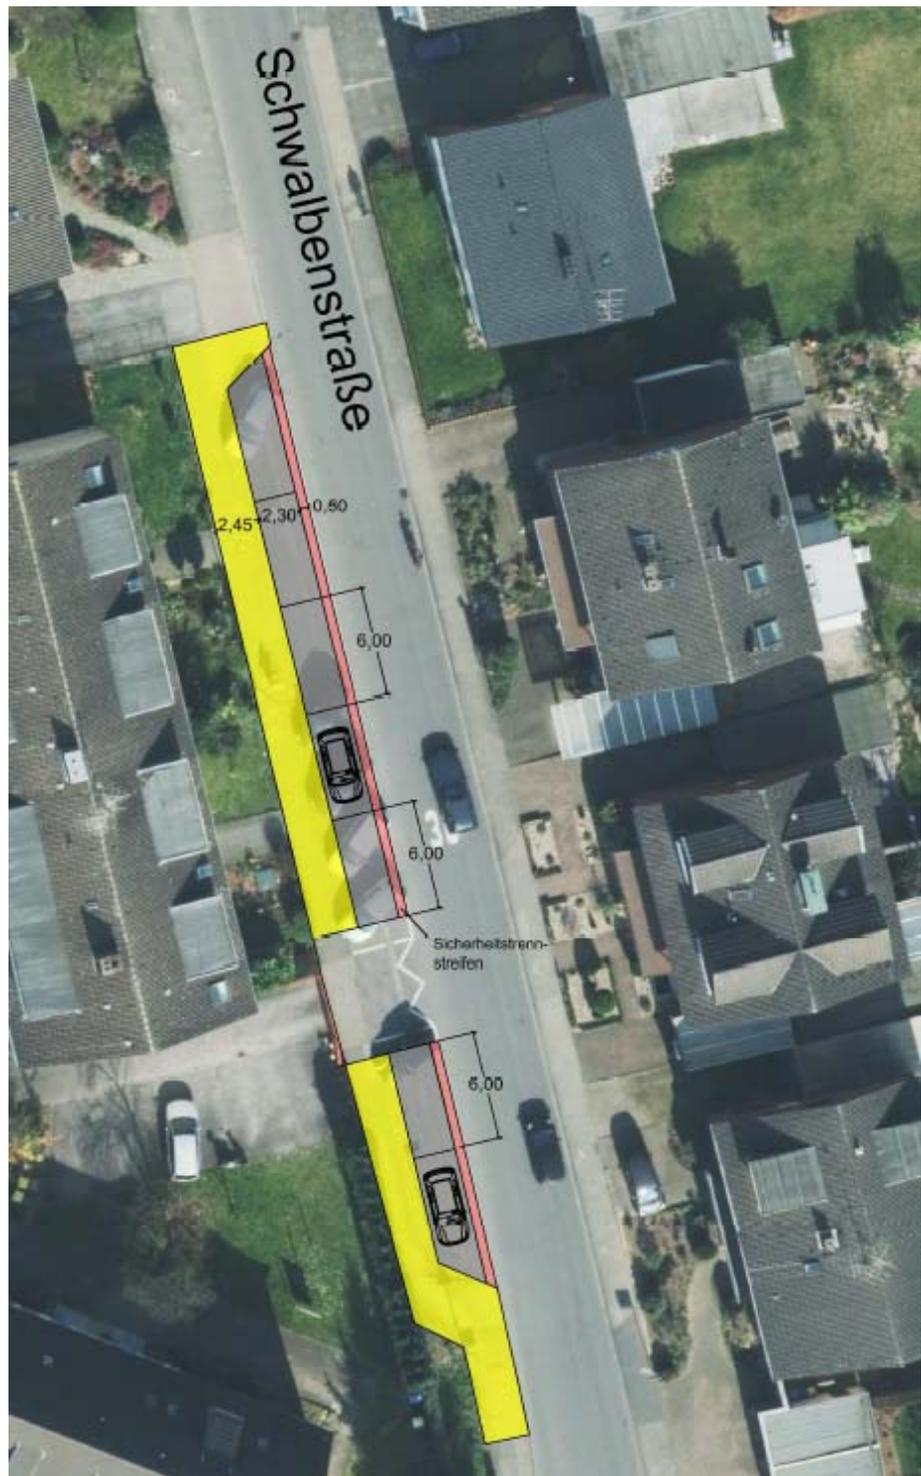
Ausschnitt aus dem Umgestaltungsplan Schwalbenstraße
